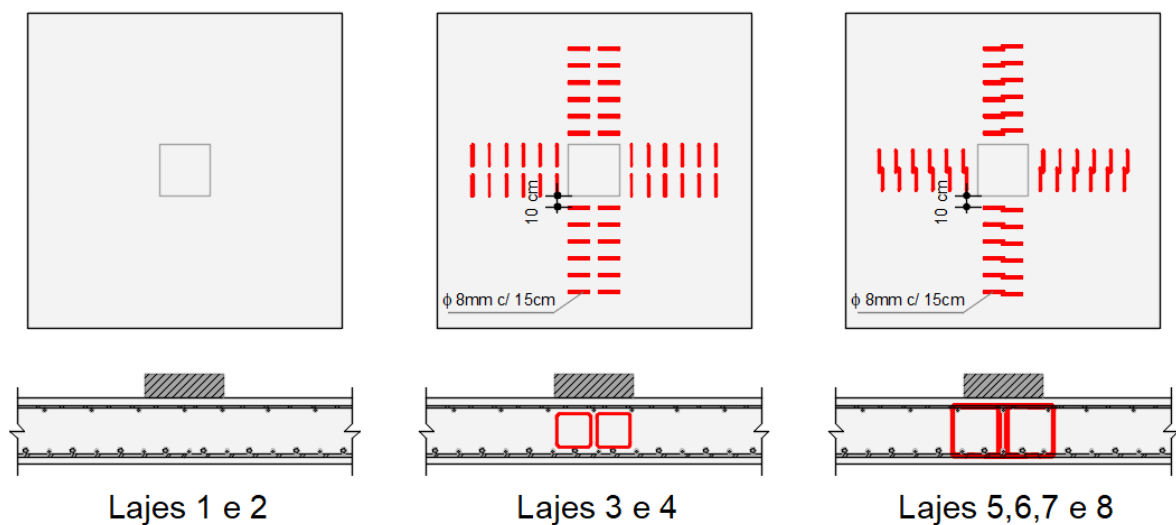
Disposição das armaduras de cisalhamento nas lajes ensaiadas
